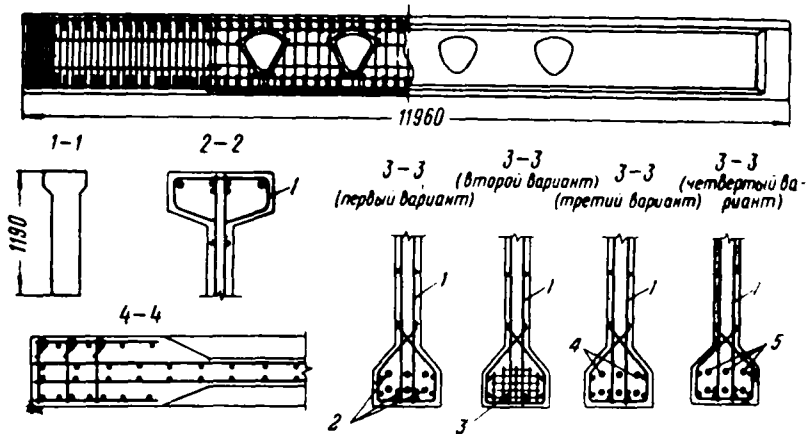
Армирование балок серии ПП-01-01/64 (на примере балки пролетом 12 м)
